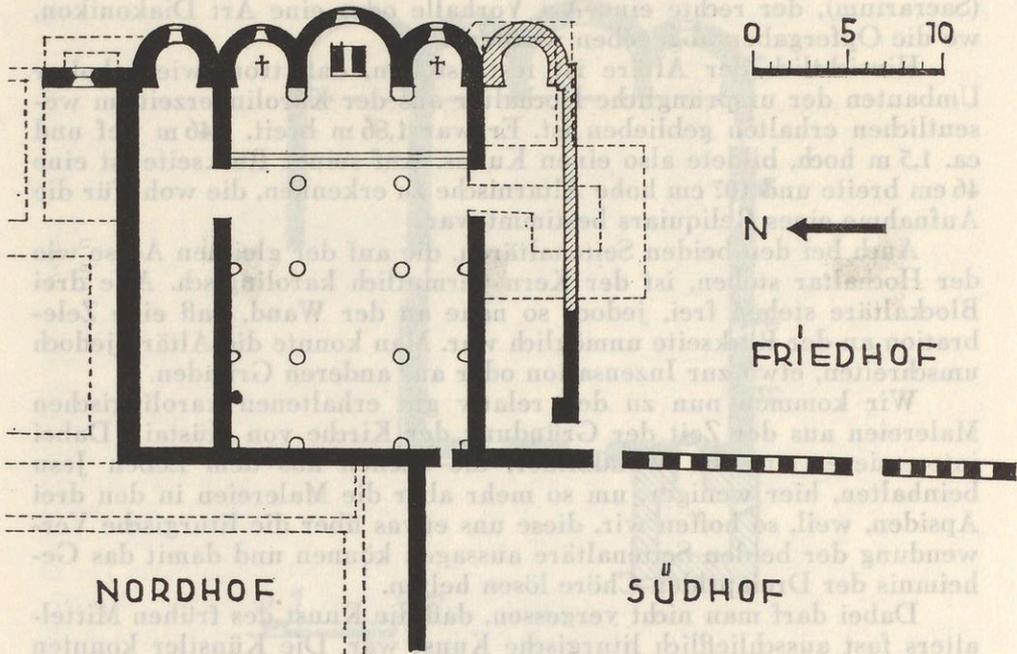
Grundriß der Kirche St. Johann in Müstair (nach Sulzer)
